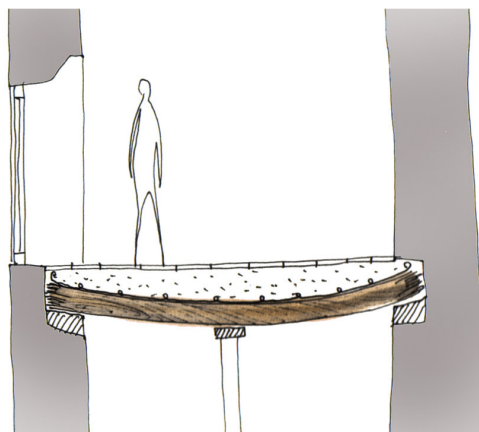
Reforço do pavimento com aumento excessivo de peso próprio
